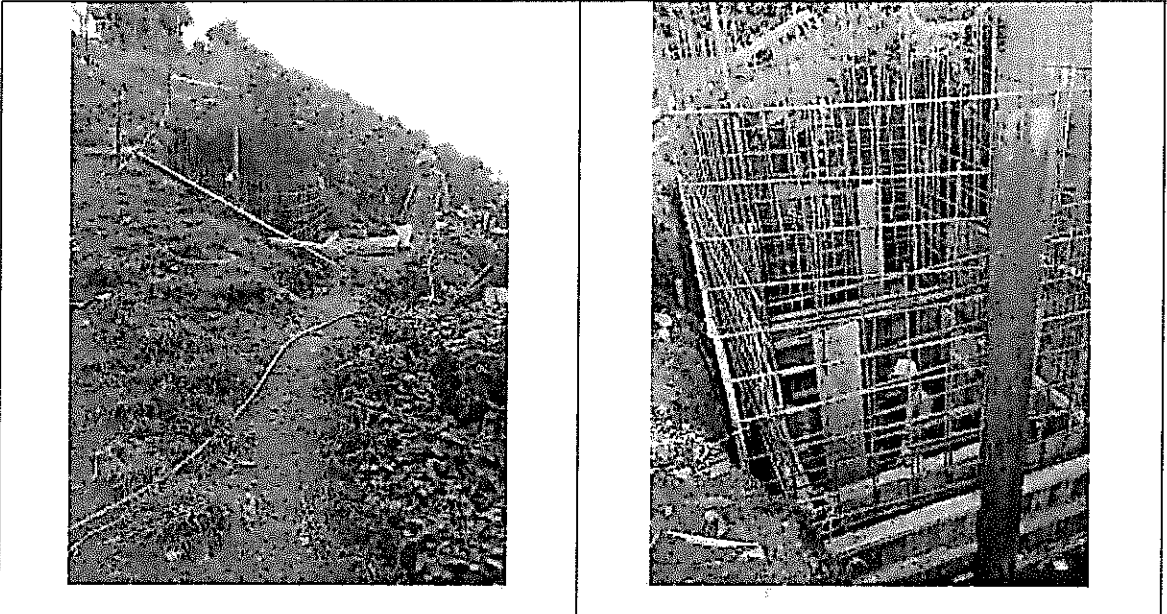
y 8. Excavación y acero de refuerzo Aliviadero.
